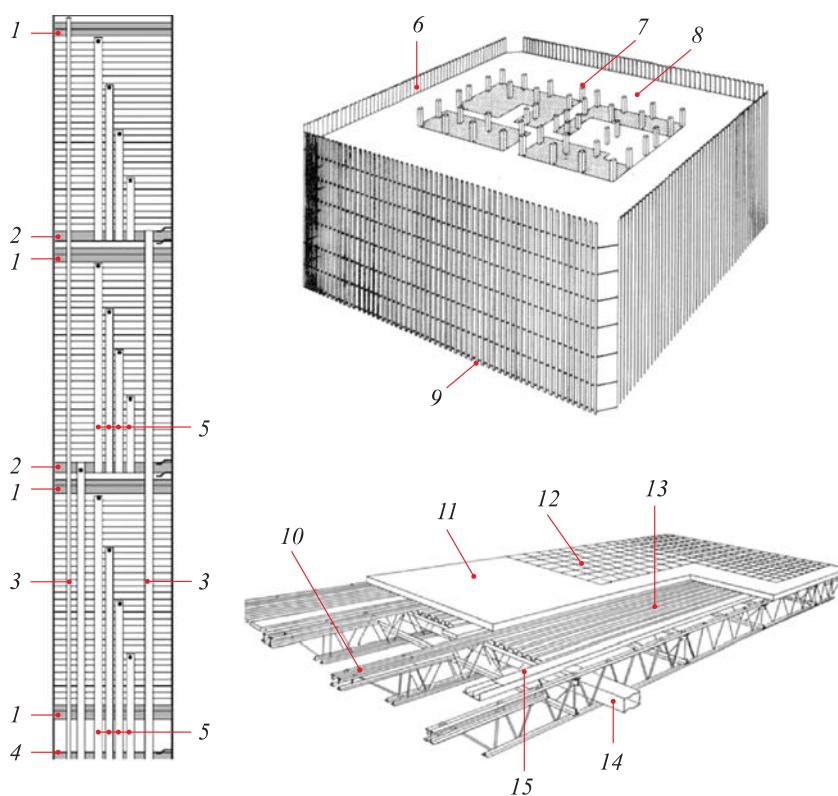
Схематичный разрез здания, схема вертикальных несущих конструкций и конструкция перекрытия [7]: 1 — техническое обслуживание; 2 — смотровая площадка; 3 — лифт-экспресс; 4 — уровень Plaza; 5 — локальный лифт; 6 — наружная поверхность трубы; 7 — центральный стержень колонны; 8 — плита перекрытия; 9 — 59 колонн с каждой стороны; 10 — стержень; 11 — бетон; 12 — покрытие пола; 13 — сквозной настил; 14 — система кондиционирования; 15 — канал для прокладки электрики
